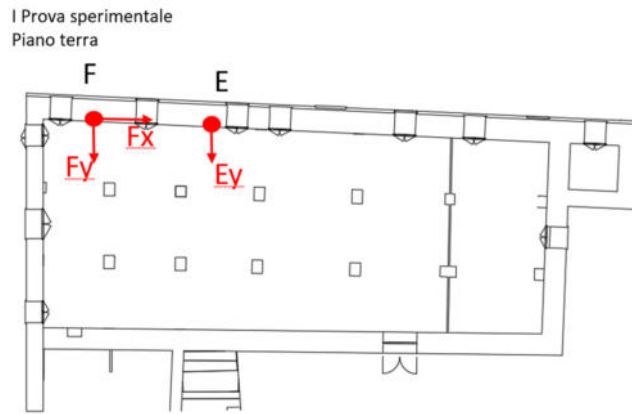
Disposizione degli accelerometri nel piano terra dell'edificio.
